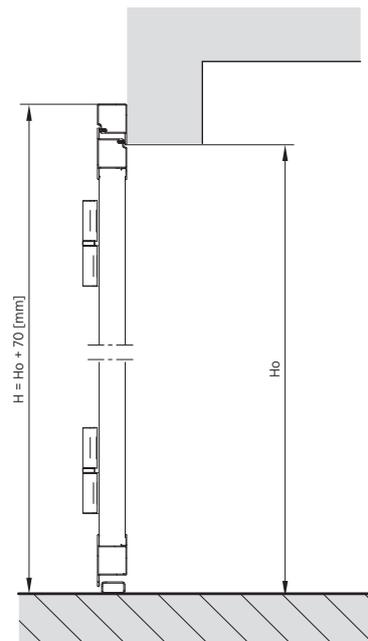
Pose devant la baie - coupe verticale - Porte battante à deux vantaux Presto 50
